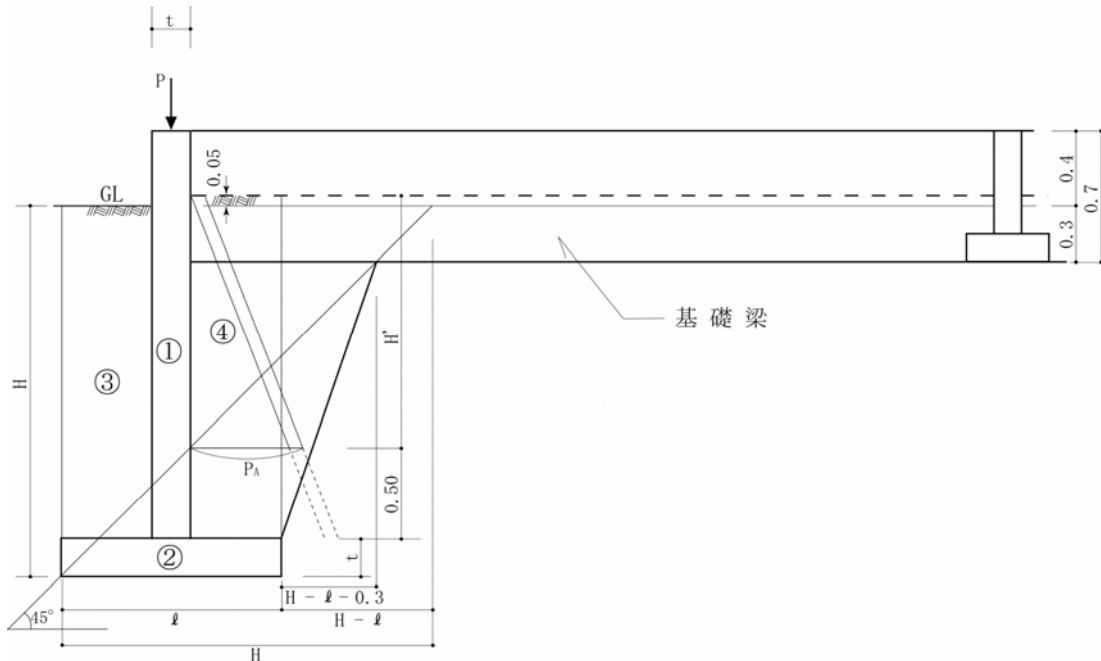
1 布基礎 - 直接基礎による立ち下げ (断面図)
